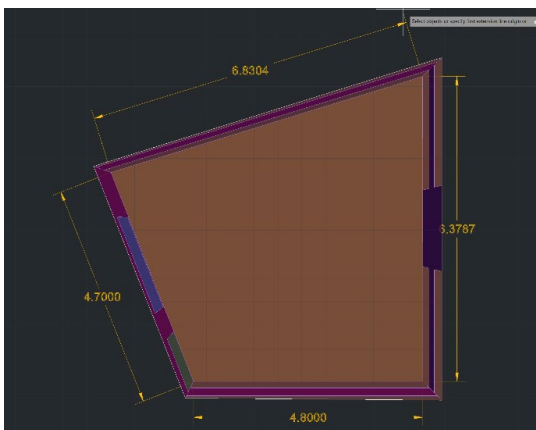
Planos de planta y perspectiva con cotas, sala de grabación.
